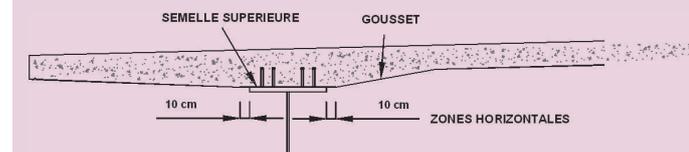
Coffrage de la dalle au voisinage des semelles supérieures des poutres principales
